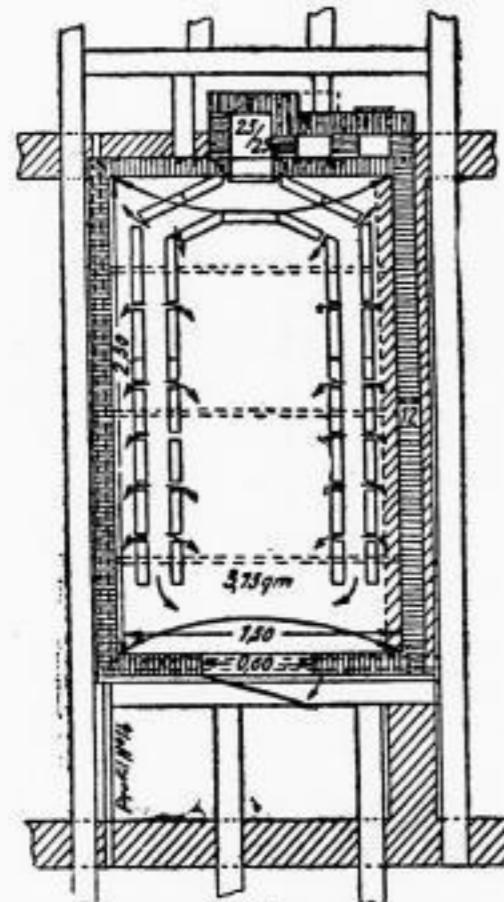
Räucherkammer im Dachboden (Grundriss).
